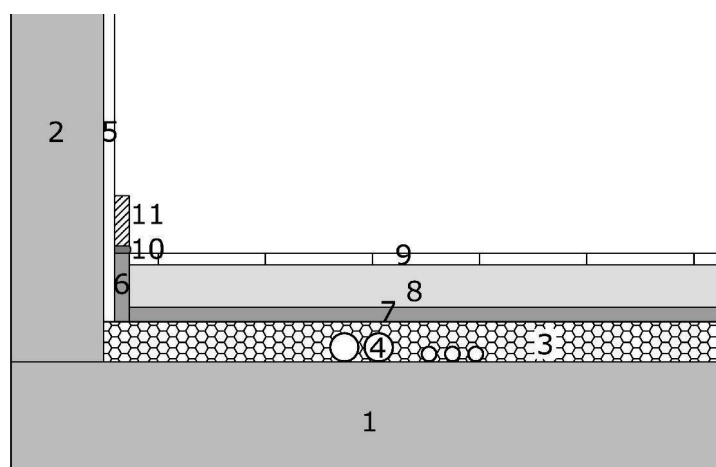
Pavimento galleggiante. Fonte: TBZ S.r.l.
